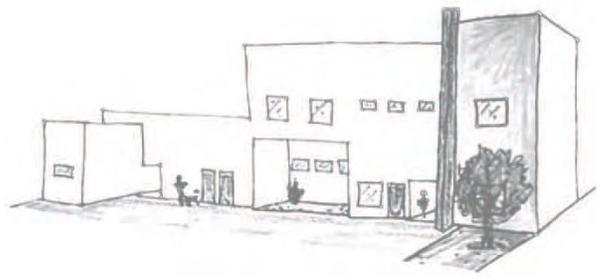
Primera propuesta de fachada posterior. Fuente A.C.
